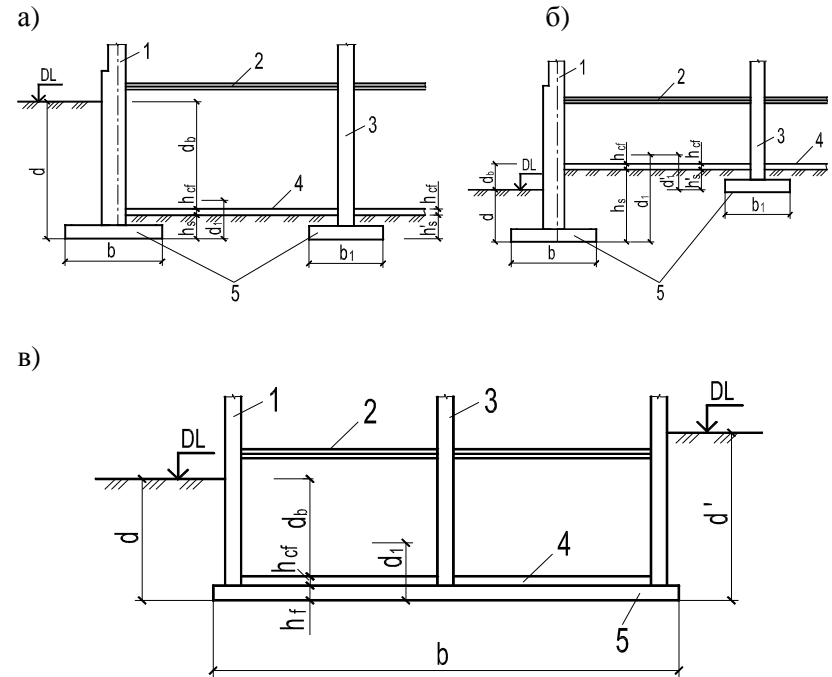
Схемы к определению расчётного сопротивления грунтов основания:
